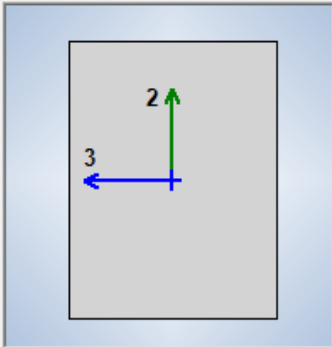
Sección transversal de las columnas 35x45cm. Fuente: Propia
